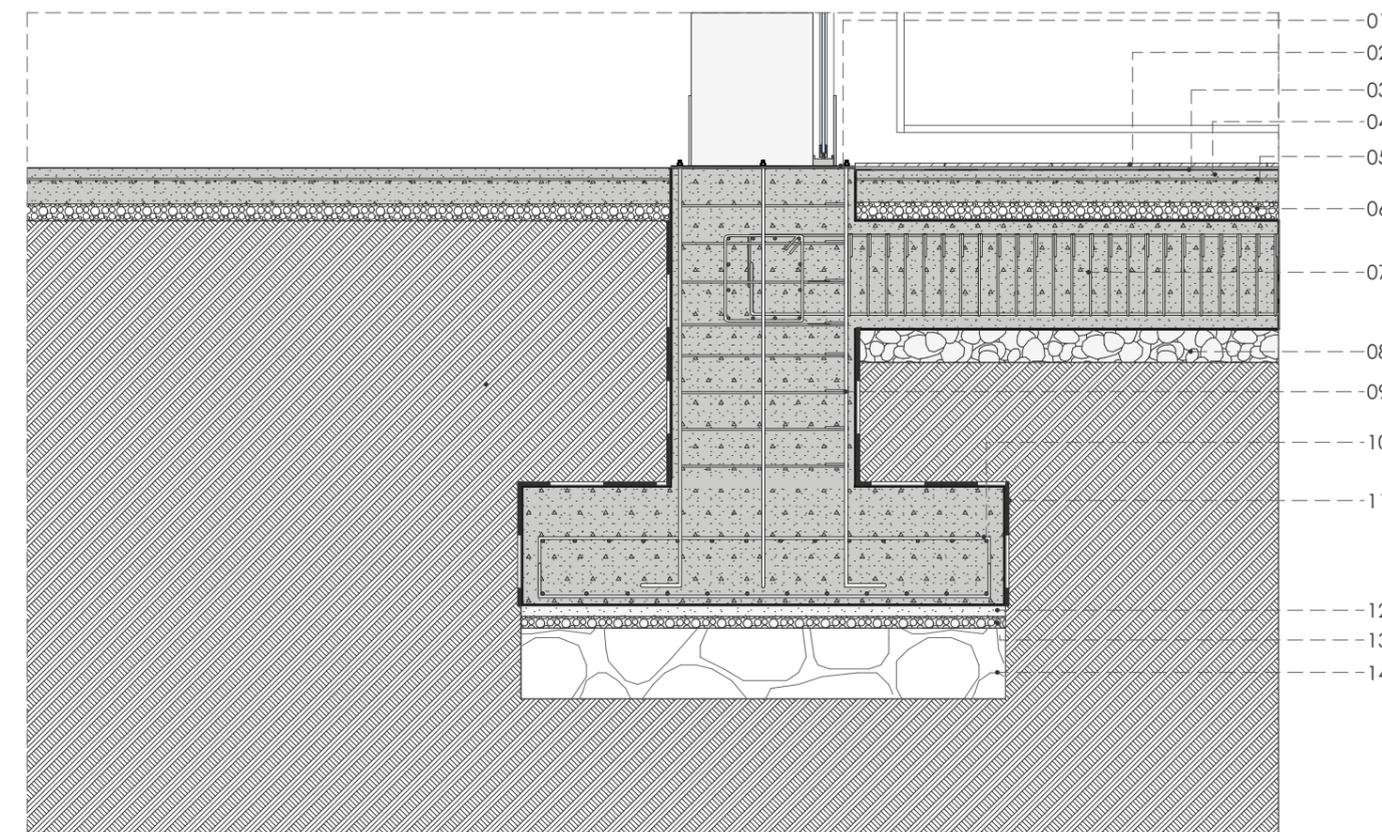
Detalle 01- zapata Fuente: Propia, 2022
